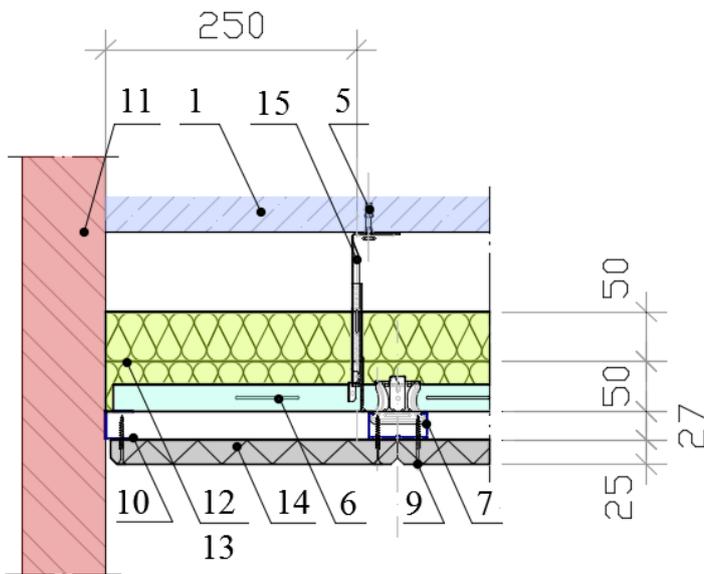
Decken- und Wandanschluss mit Schattenfuge
